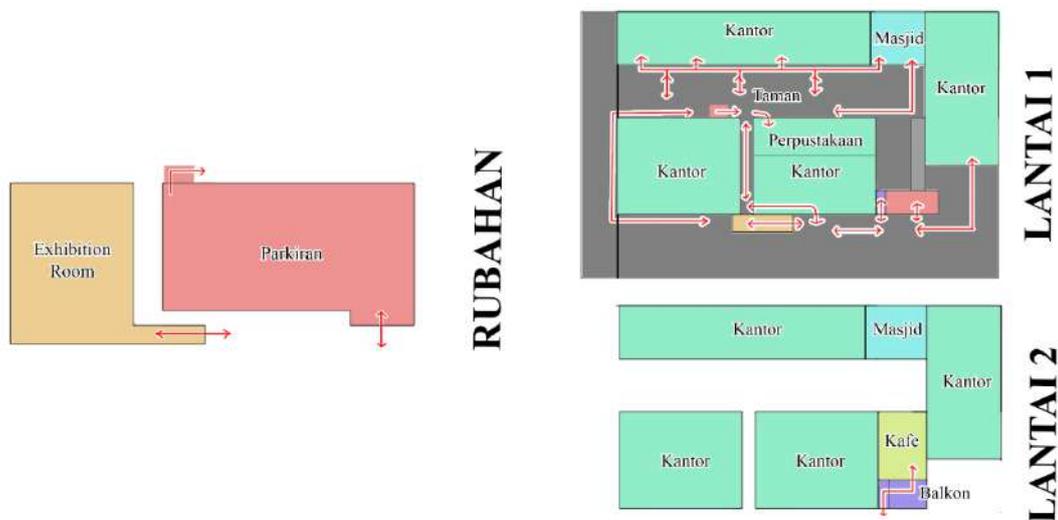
Blockplan Alun-Alun Kota Surabaya
